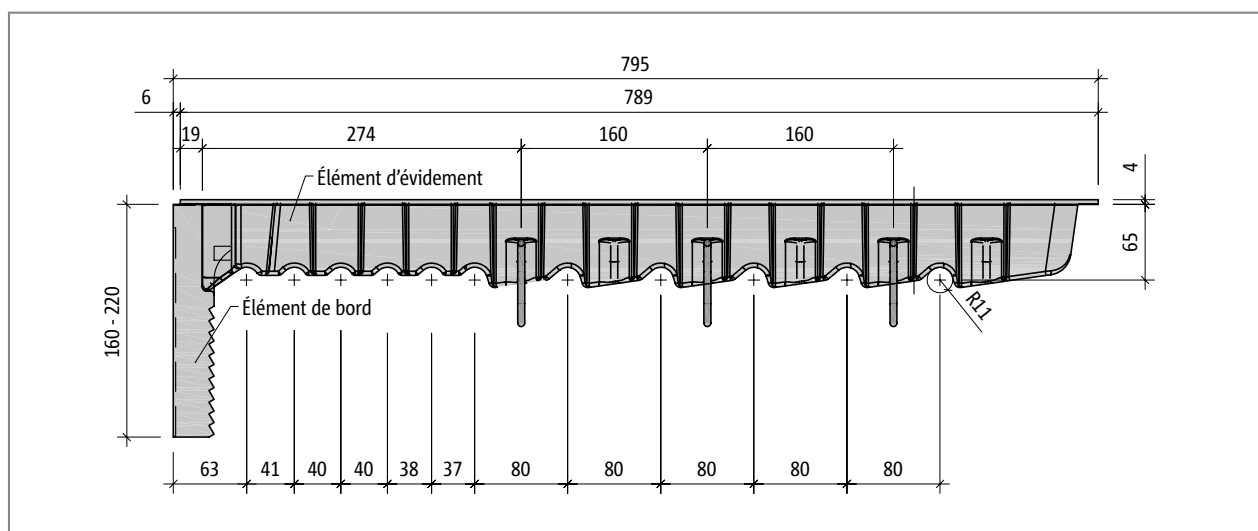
Schöck IDock® : coupe transversale, IDock2
